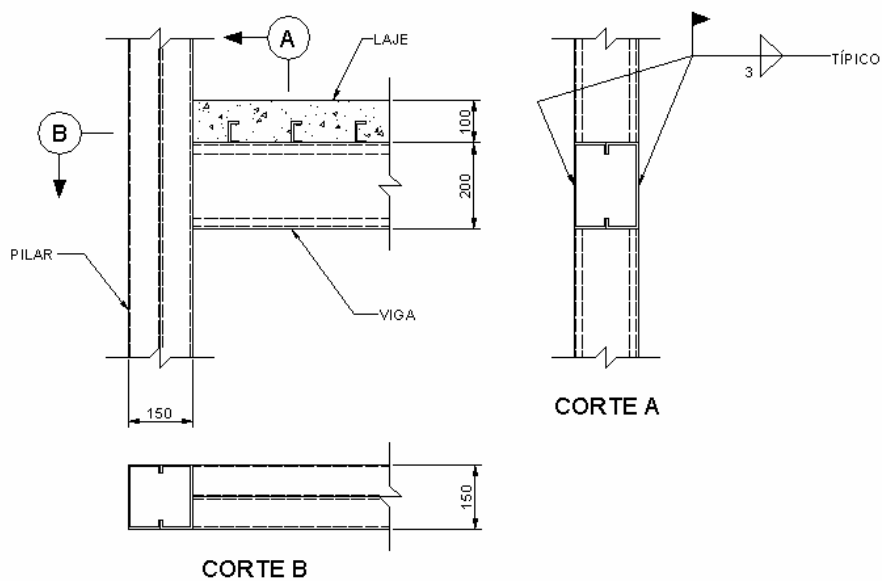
Detalhe construtivo da ligação Viga – Pilar na direcção x [3]
